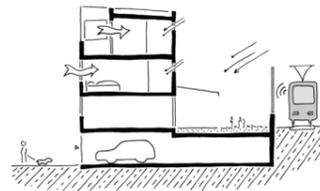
Prinzip einer Lärmschutzbebauung mit geringer Raumtiefe und ergänzendem aktivem Lärmschutz
